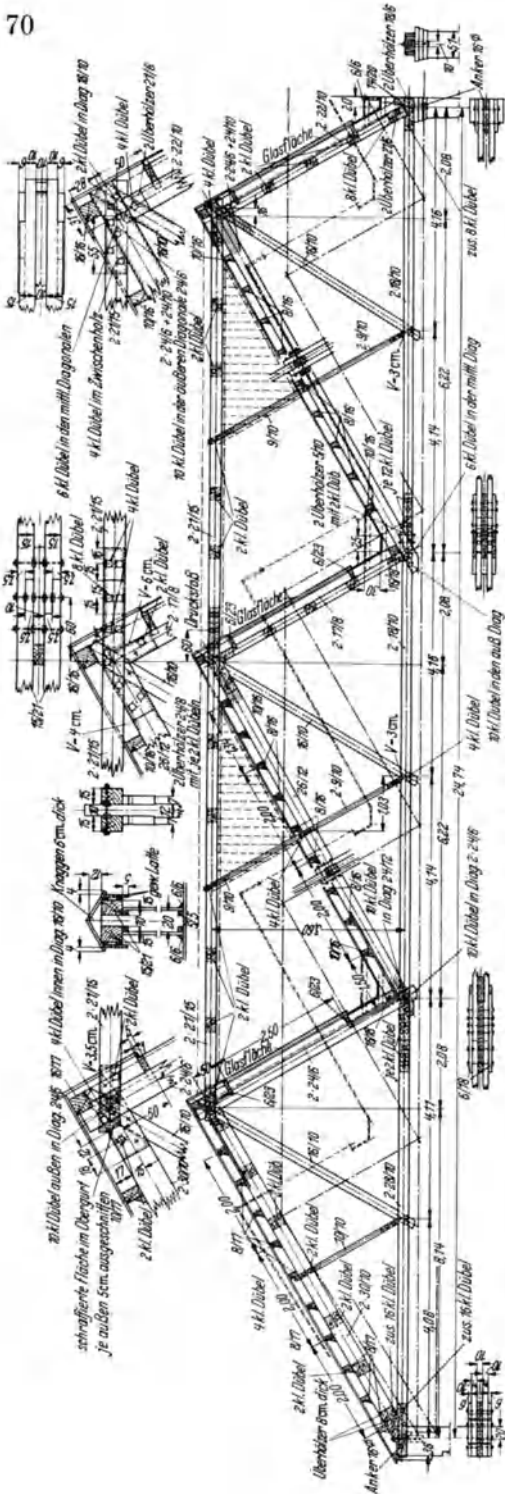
Shedhalle für eine Kunstseidefabrik.
